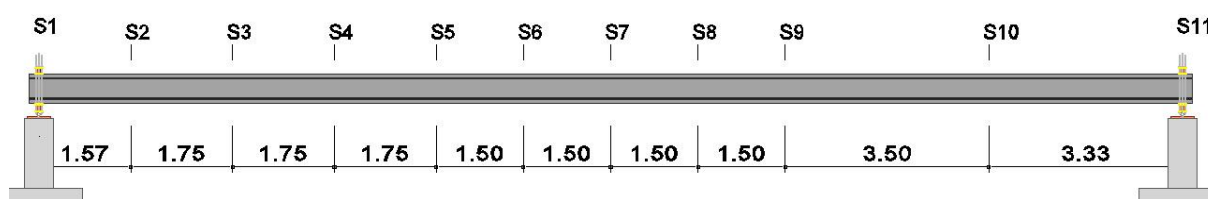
Definição e localização das secções instrumentadas nas vigas
